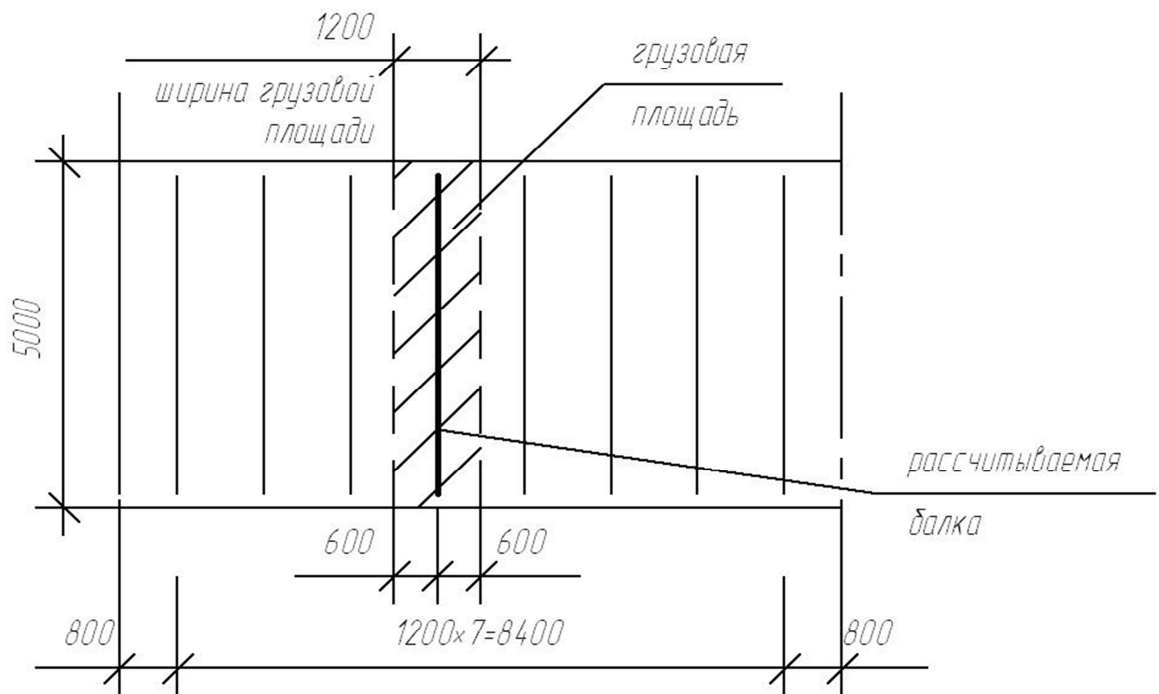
Определение грузовой площади на наиболее нагруженную балку
